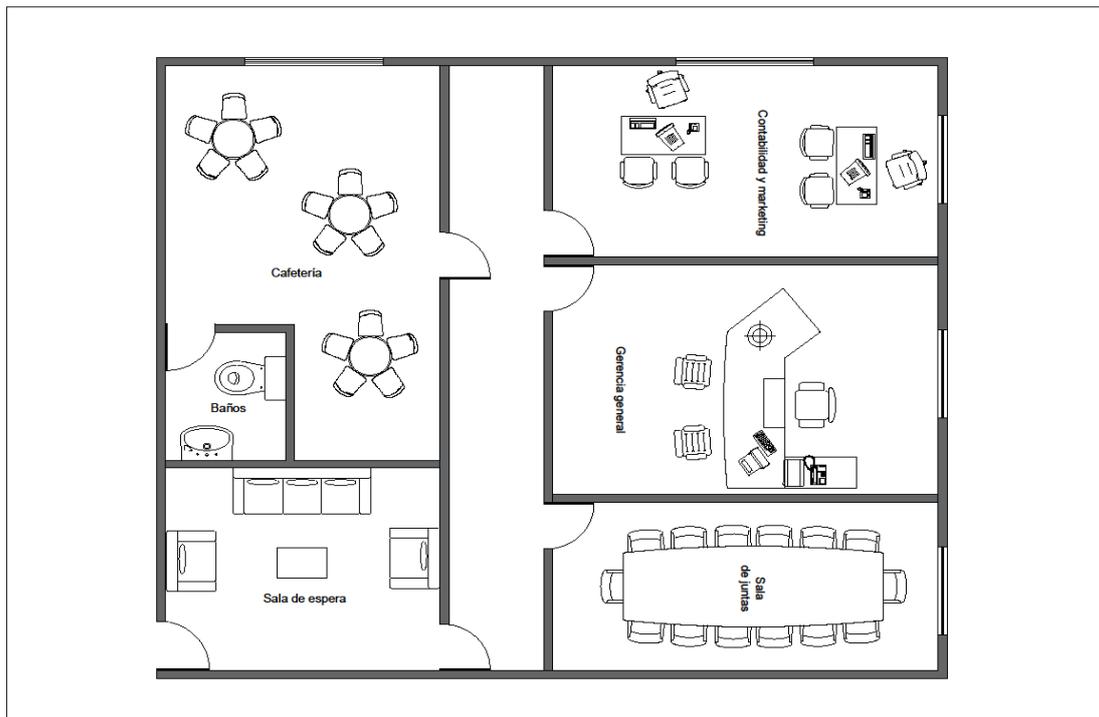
Distribución de la planta de elaboración de Licores (Planta Alta).
